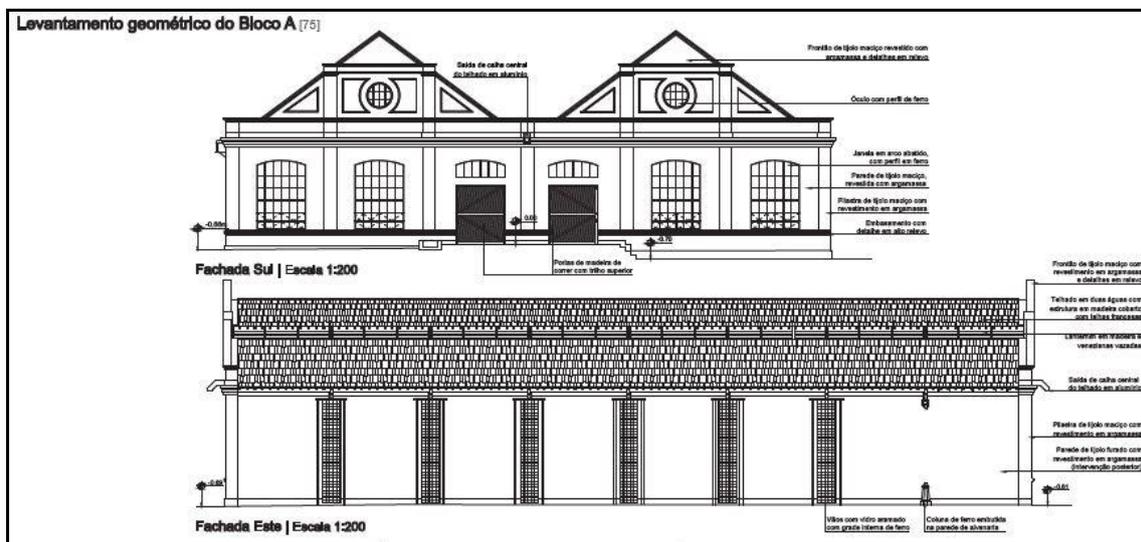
Levantamento cadastral das fachadas Sul e Leste do Museu do Trem.
